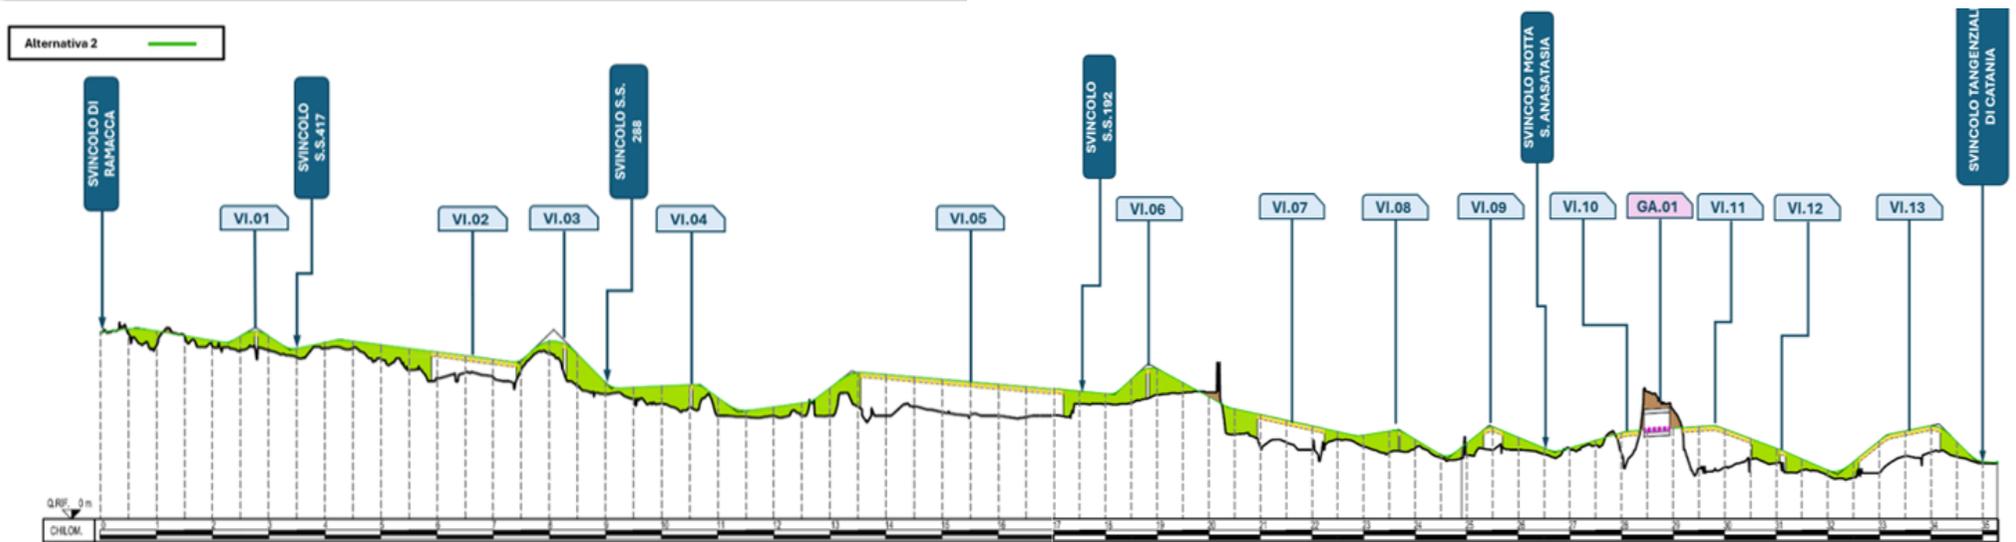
PROFILO LONGITUDINALE DI PROGETTO – ALTERNATIVA 2
